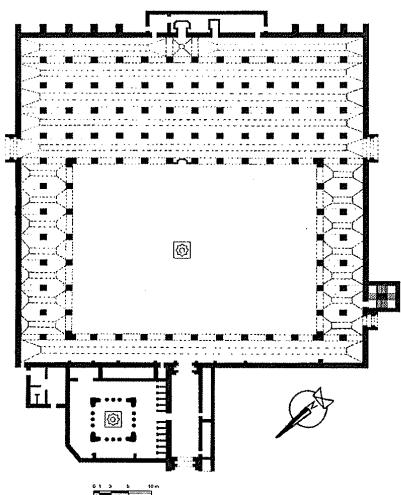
مسقّط أفقى لجامع تازة الموحدى.
